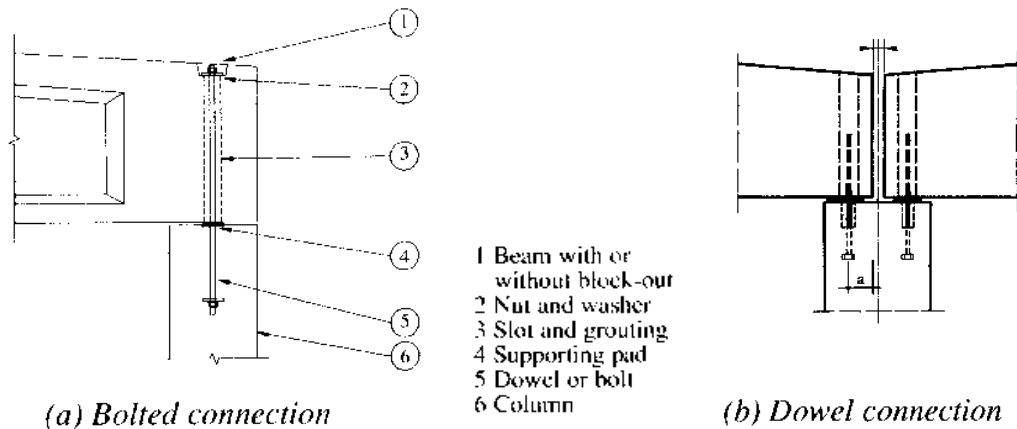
Assemblage poteau-poutre « articulation ». L'assemblage boulonné assure un meilleur chaînage.
